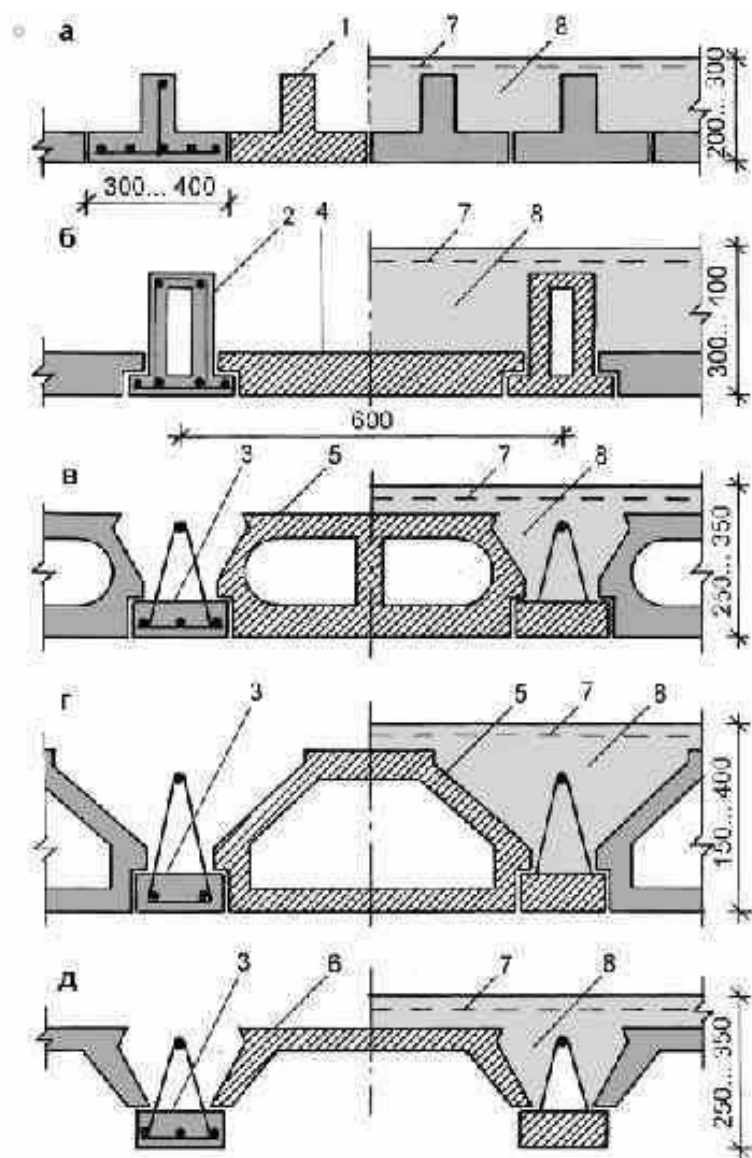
Сборно-монолитные перекрытия с применением балок:
